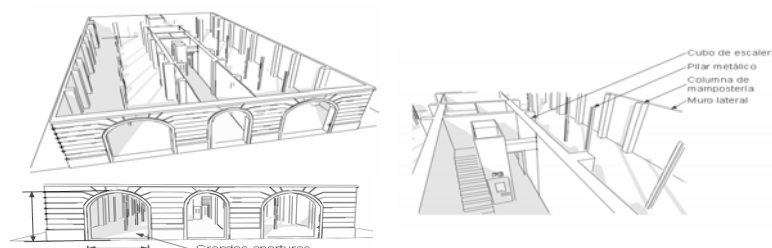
Planta baja del edificio modelo M-153, con detalles.
